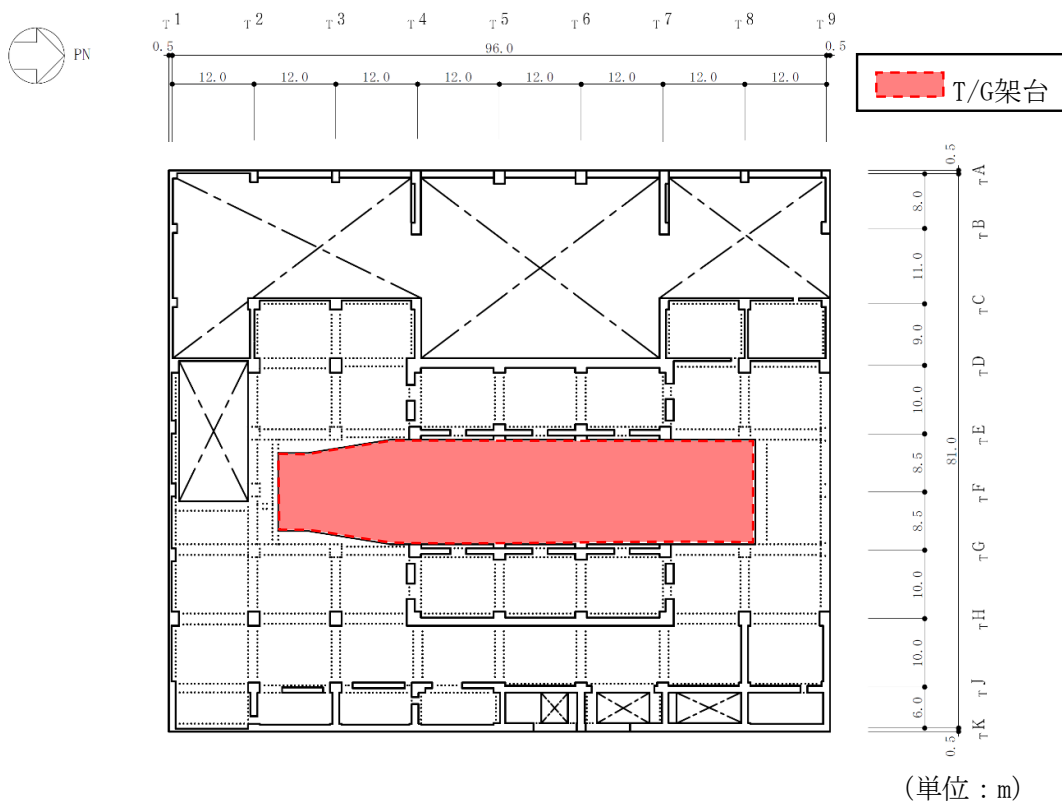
タービン建屋の概略平面図（2F, T.M.S.L. 20.4m）(2/2)
